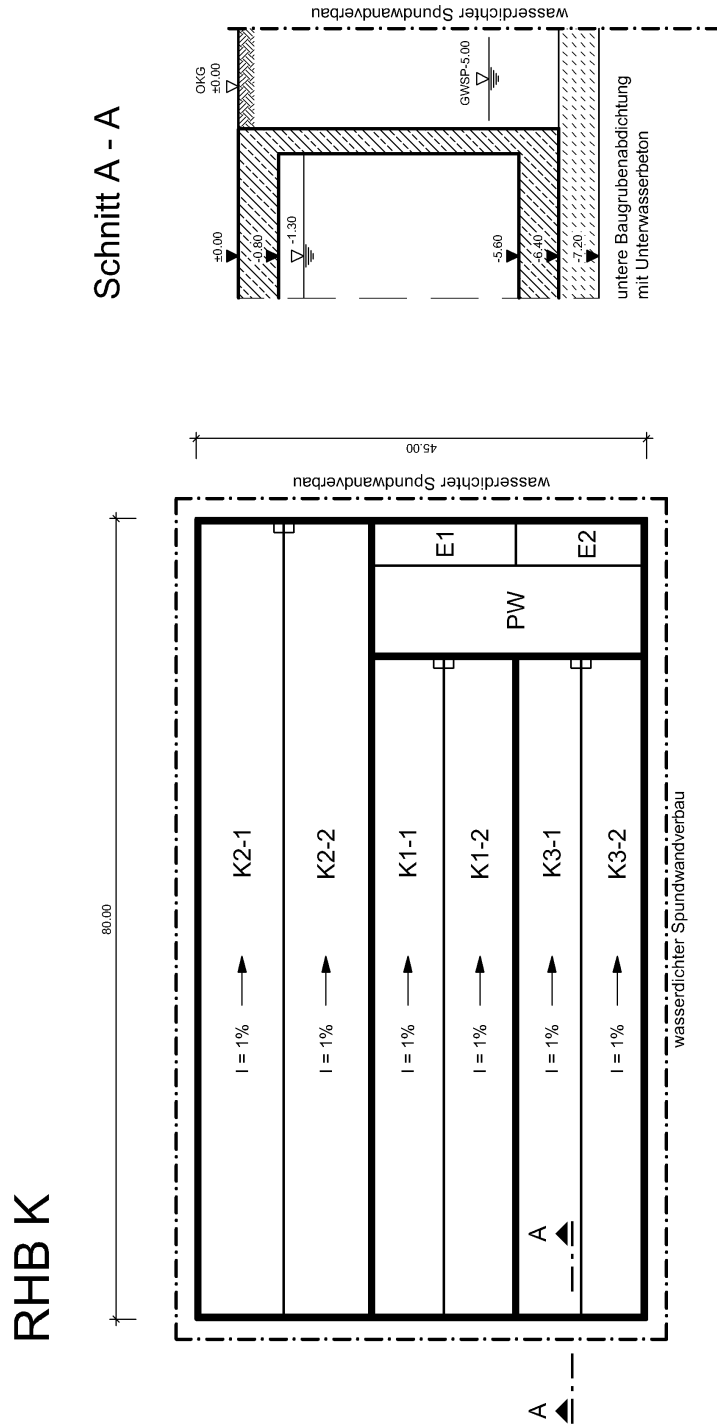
Grundriss und Schnitt RHB K
